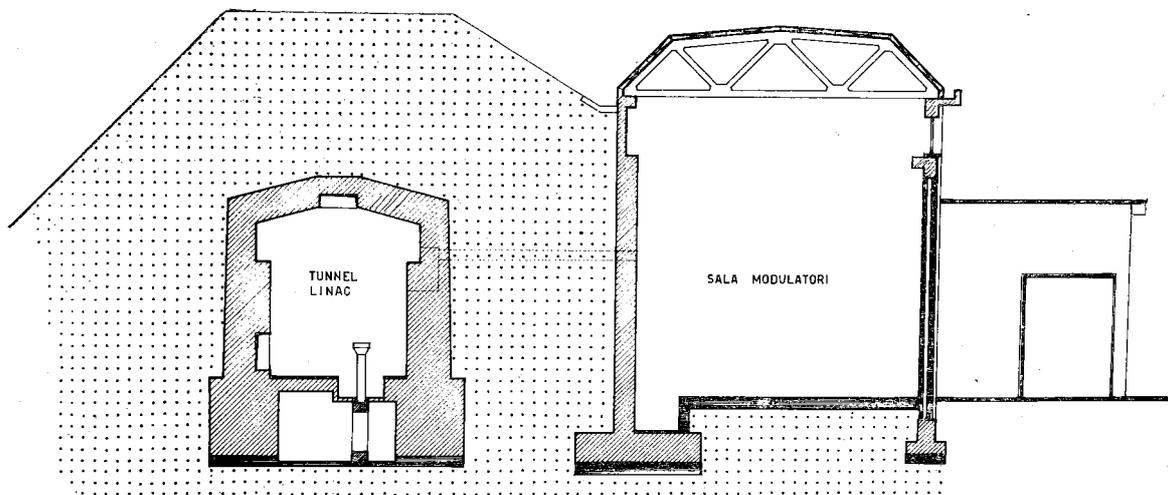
Sezione tunnel Linac ed edificio modulatori.
